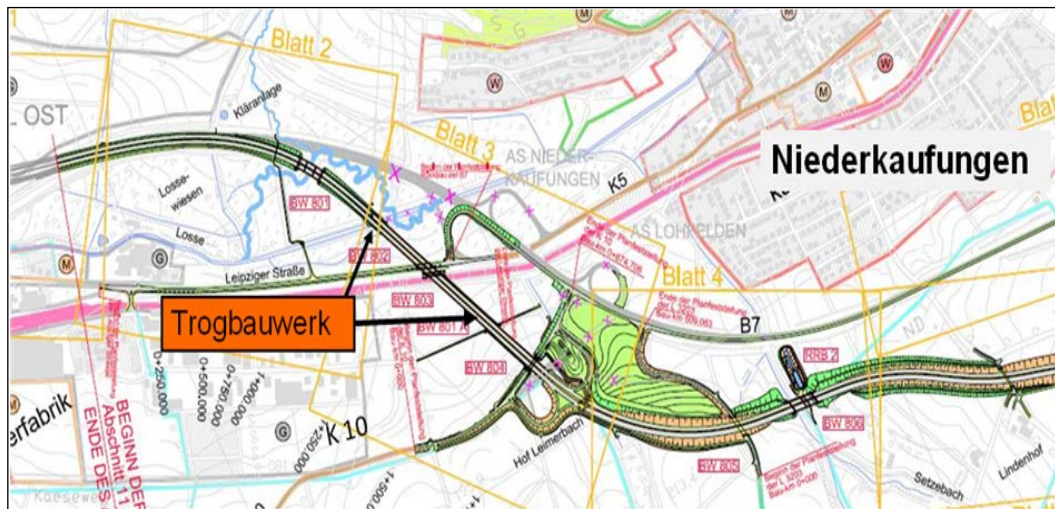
Lageplan BAB A 44 bei Niederkaufungen (Planfeststellungsentswurf 2006)
